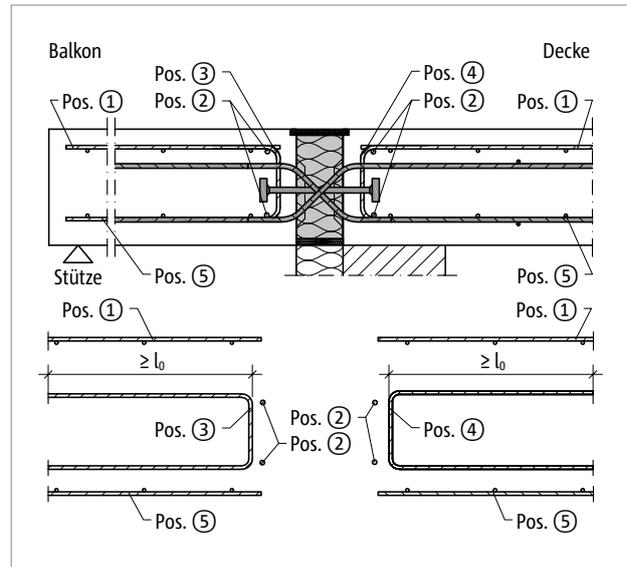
Schöck Isokorb® T Typ Q-P-VV: Bauseitige Bewehrung
